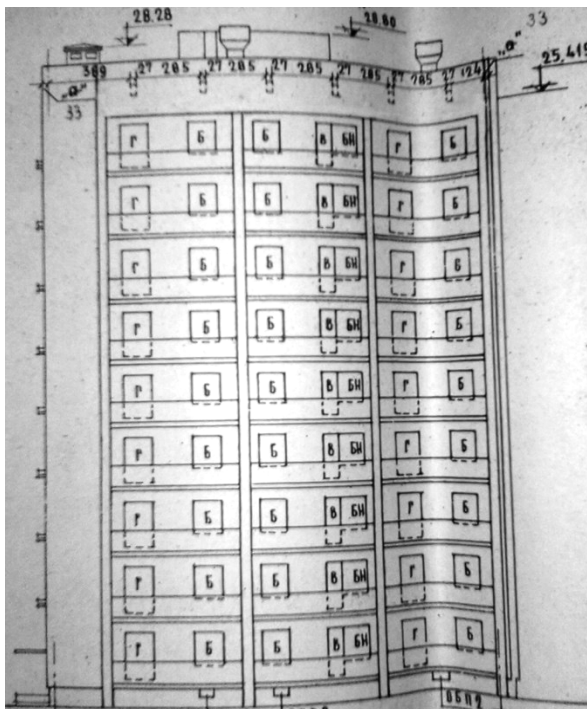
Вариант фасада дома с перекрытием лоджии 9-го этажа на отметке плит покрытия дома
